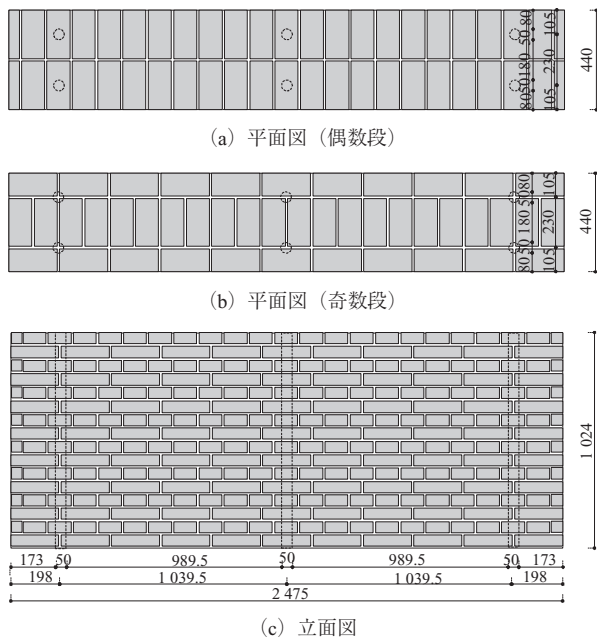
試験体の形状・寸法と PC 鋼棒用のコア穴の位置
